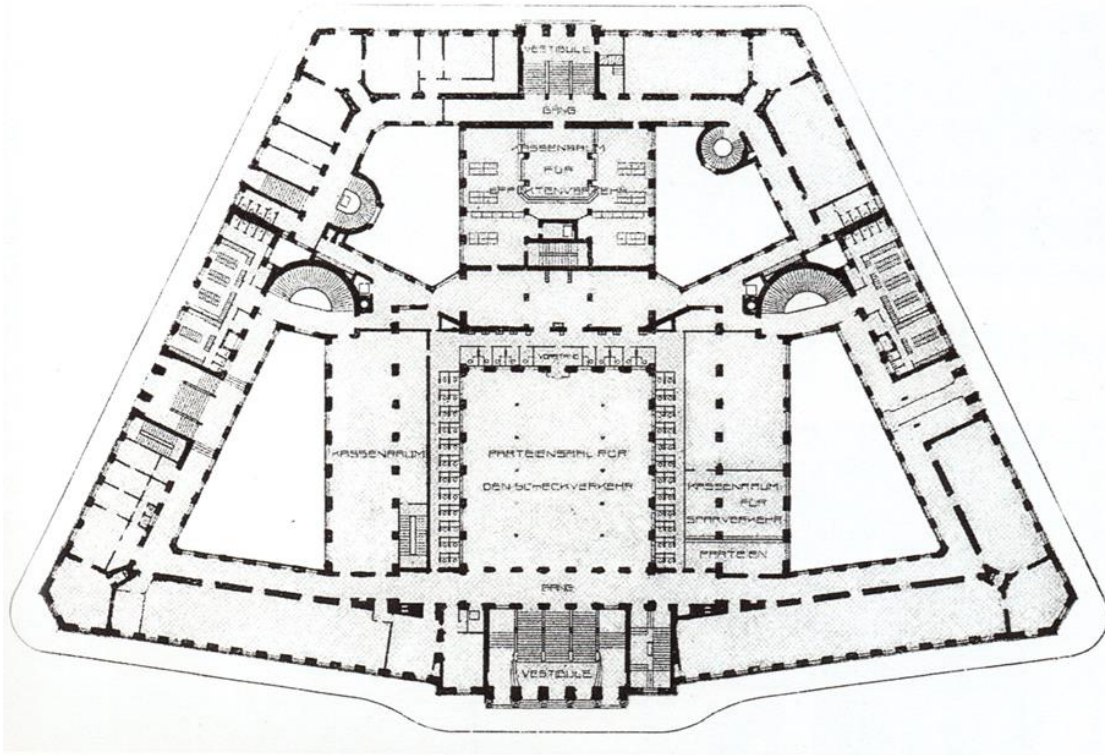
Grundriss Hochparterre, Österreichische Postsparkasse, Otto Wagner, 1906
